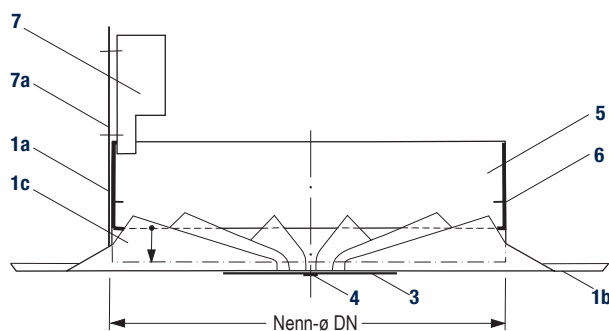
Verstellbarer Radialauslass mit runder Sichtfläche
